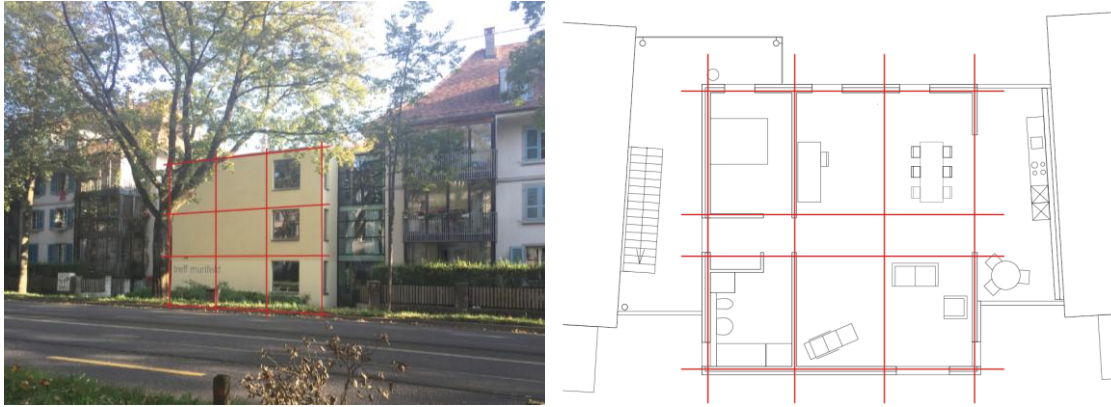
Treff Murifeld, Bern, Bild und Grundriss / Bauart Architekten und Planer AG
